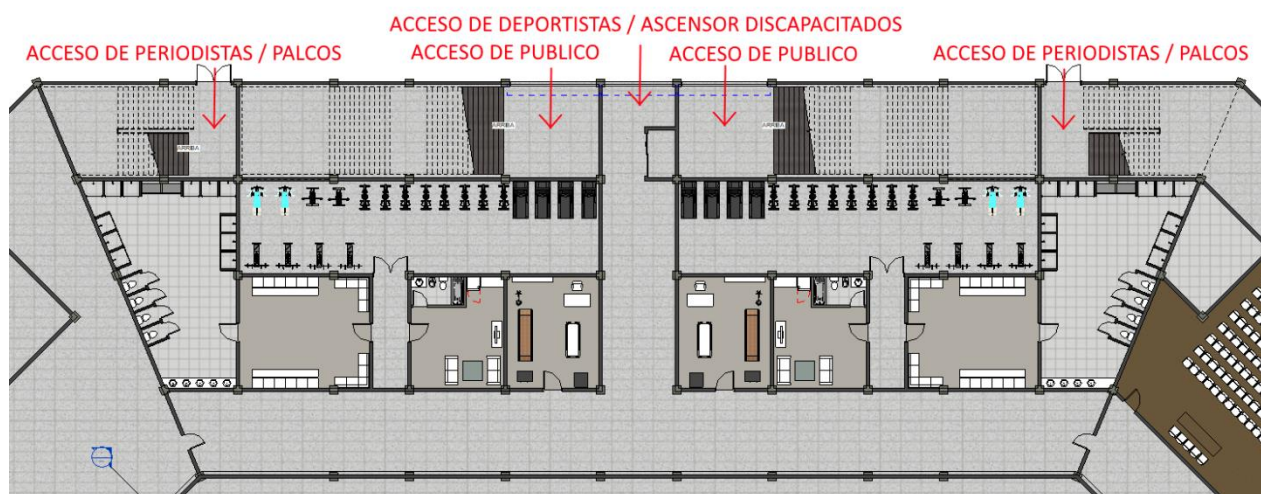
Vista en planta de los accesos del sector norte, en planta baja. Ala de deportistas. Fuente: elaboración propia.
